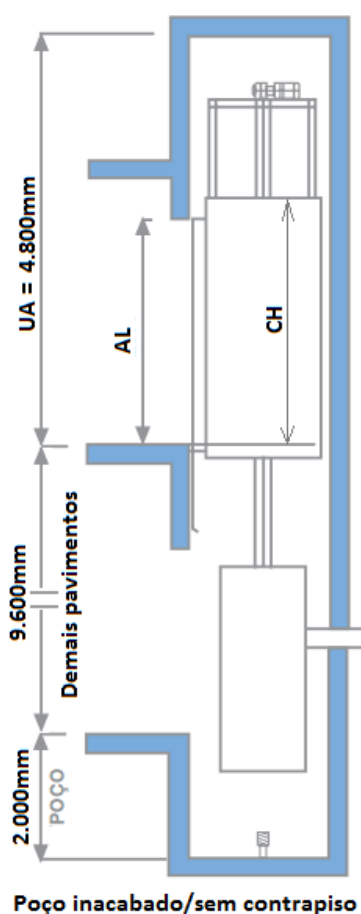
Croqui em elevação da caixa de corrida do elevador evidenciando última altura e profundidade do poço
